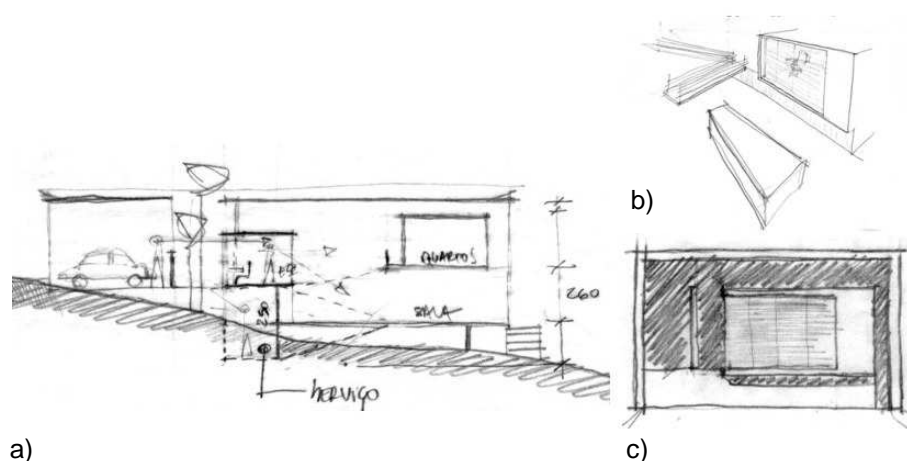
Corte longitudinal, perspectiva interna e elevação interna
